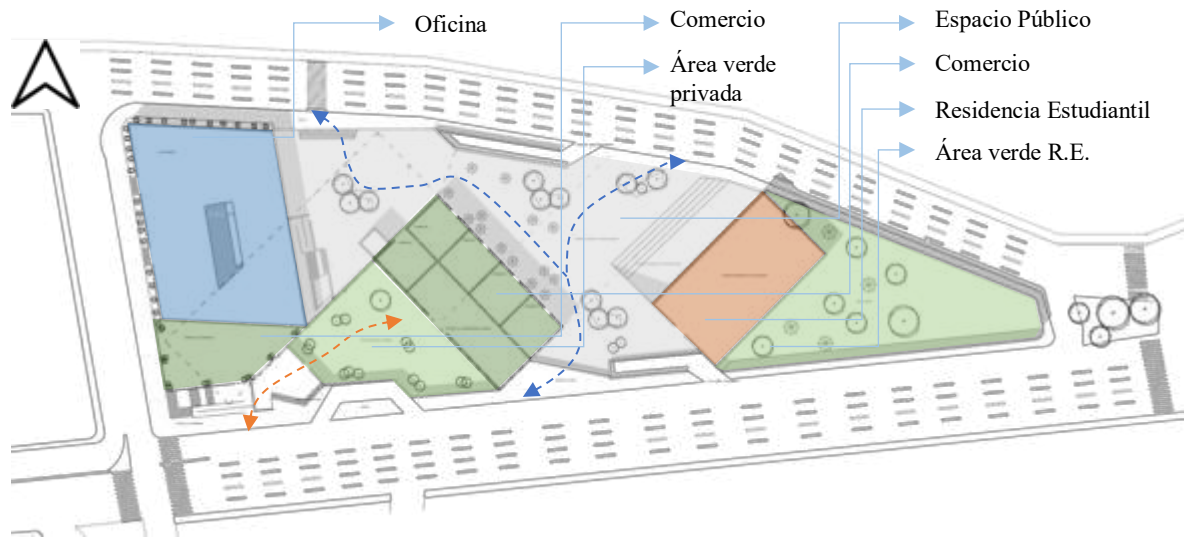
Propuesta de zonificación de conjunto en planta baja, etapa c.
